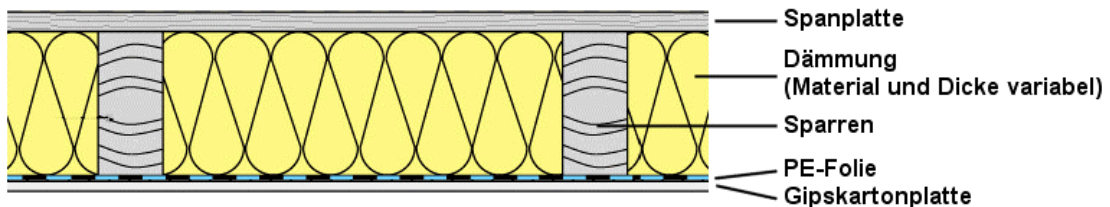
Grundaufbau der Holz-Geschossdecken
